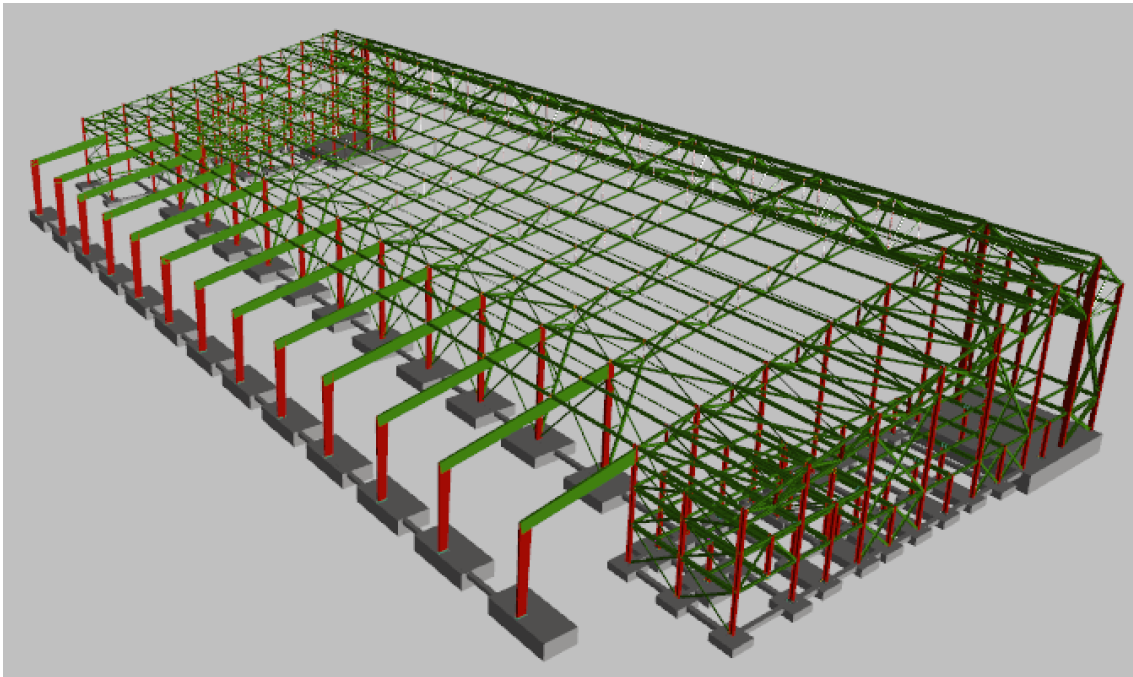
CYPE 3D – Estructura completa con su cimentación
